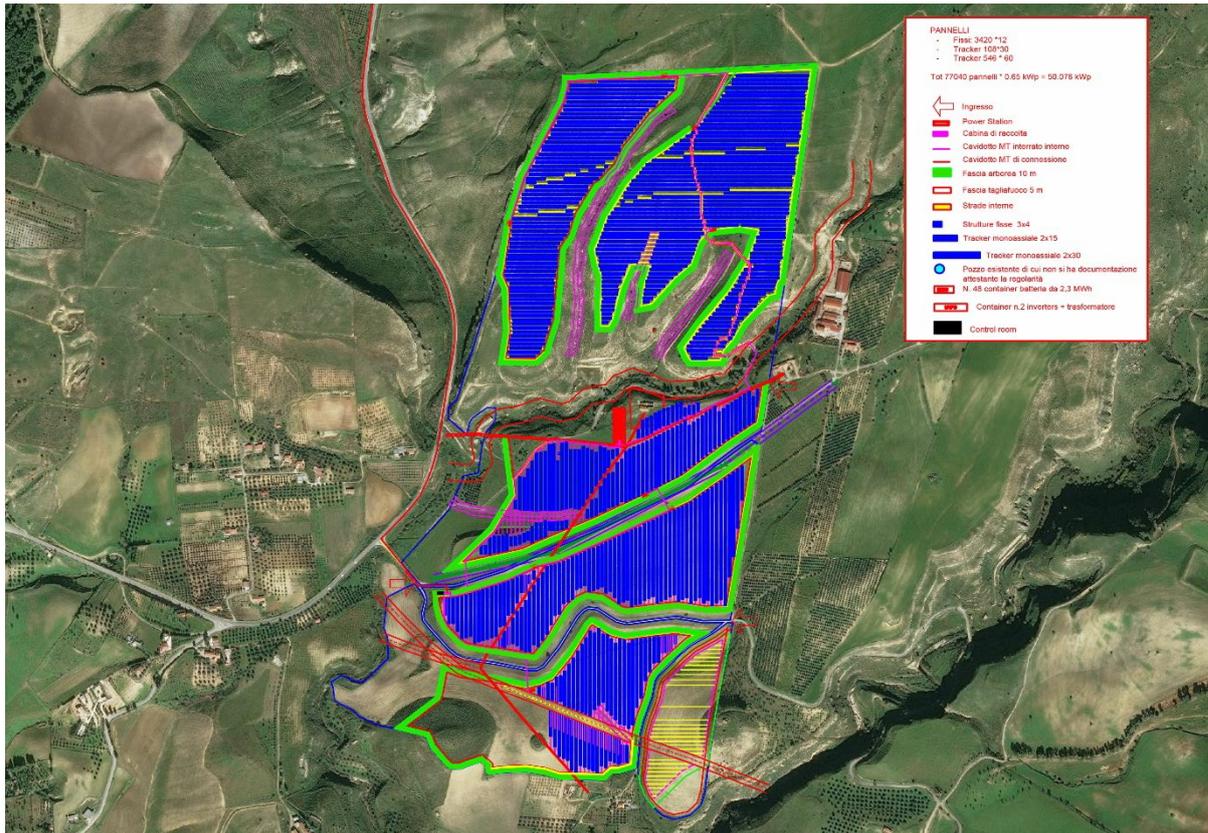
Layout dell'Impianto fotovoltaico "Enna 2" su ortofoto.
